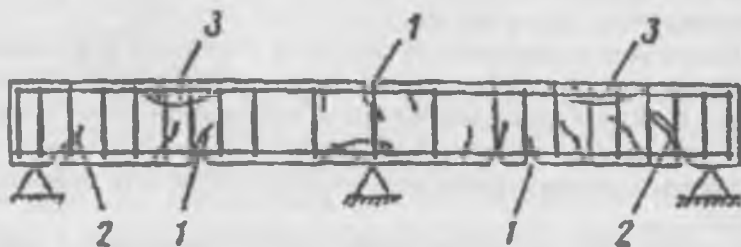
Характерные трещины в изгибаемых железобетонных элементах, работающих по балочной схеме:
